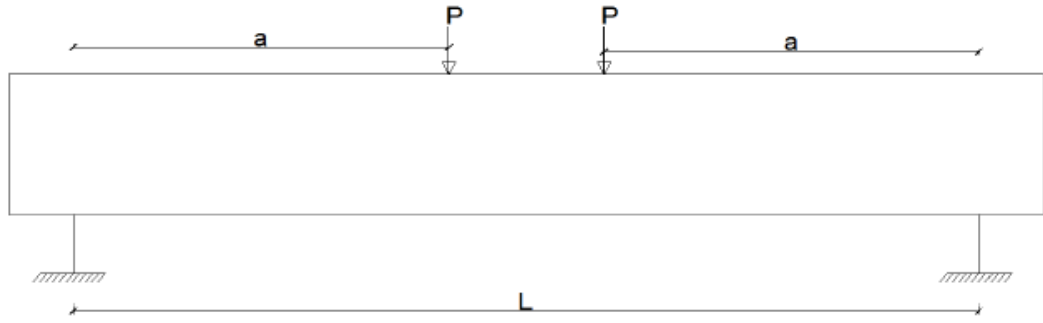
Betonarme kiriş yükleme deney düzeneği
